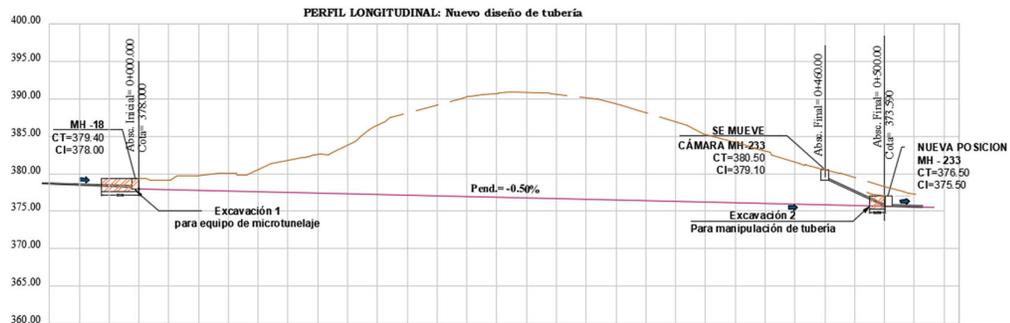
Perfil longitudinal en zona de conexión de sistemas- (Fuente: Autor)
